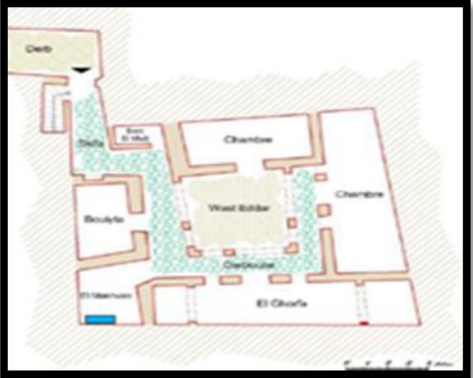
Plan du rez-de-chaussée de Dar Ben Tabet
